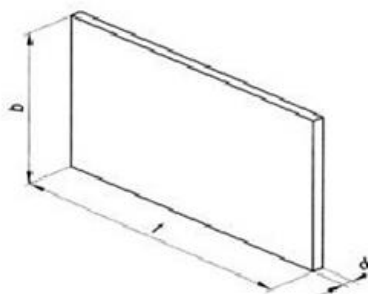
Dimensões das placas para revestimentos de paredes e escadas
